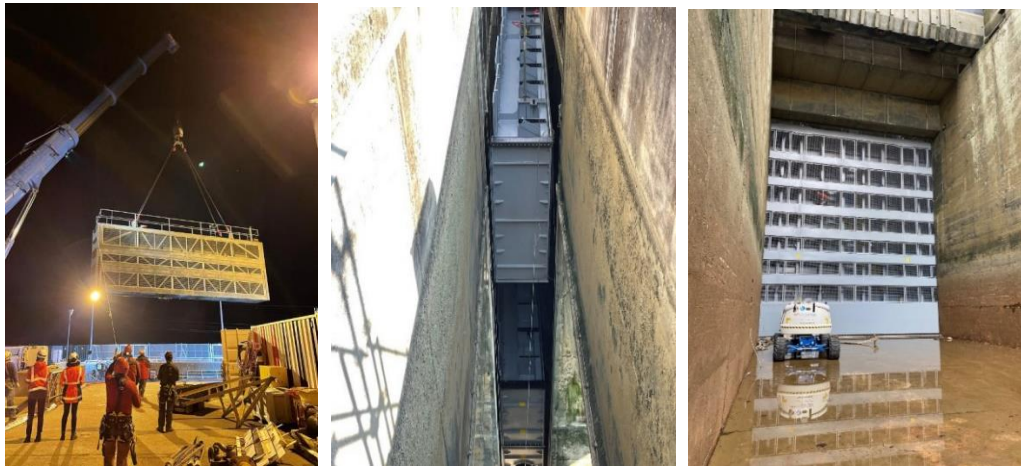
Photos chantier – retrait ancienne porte et montage nouveaux équipements
